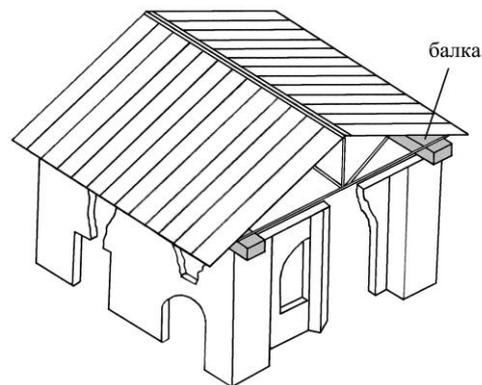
Схема устройства защитной конструкции с опиранием на стены апсиды
